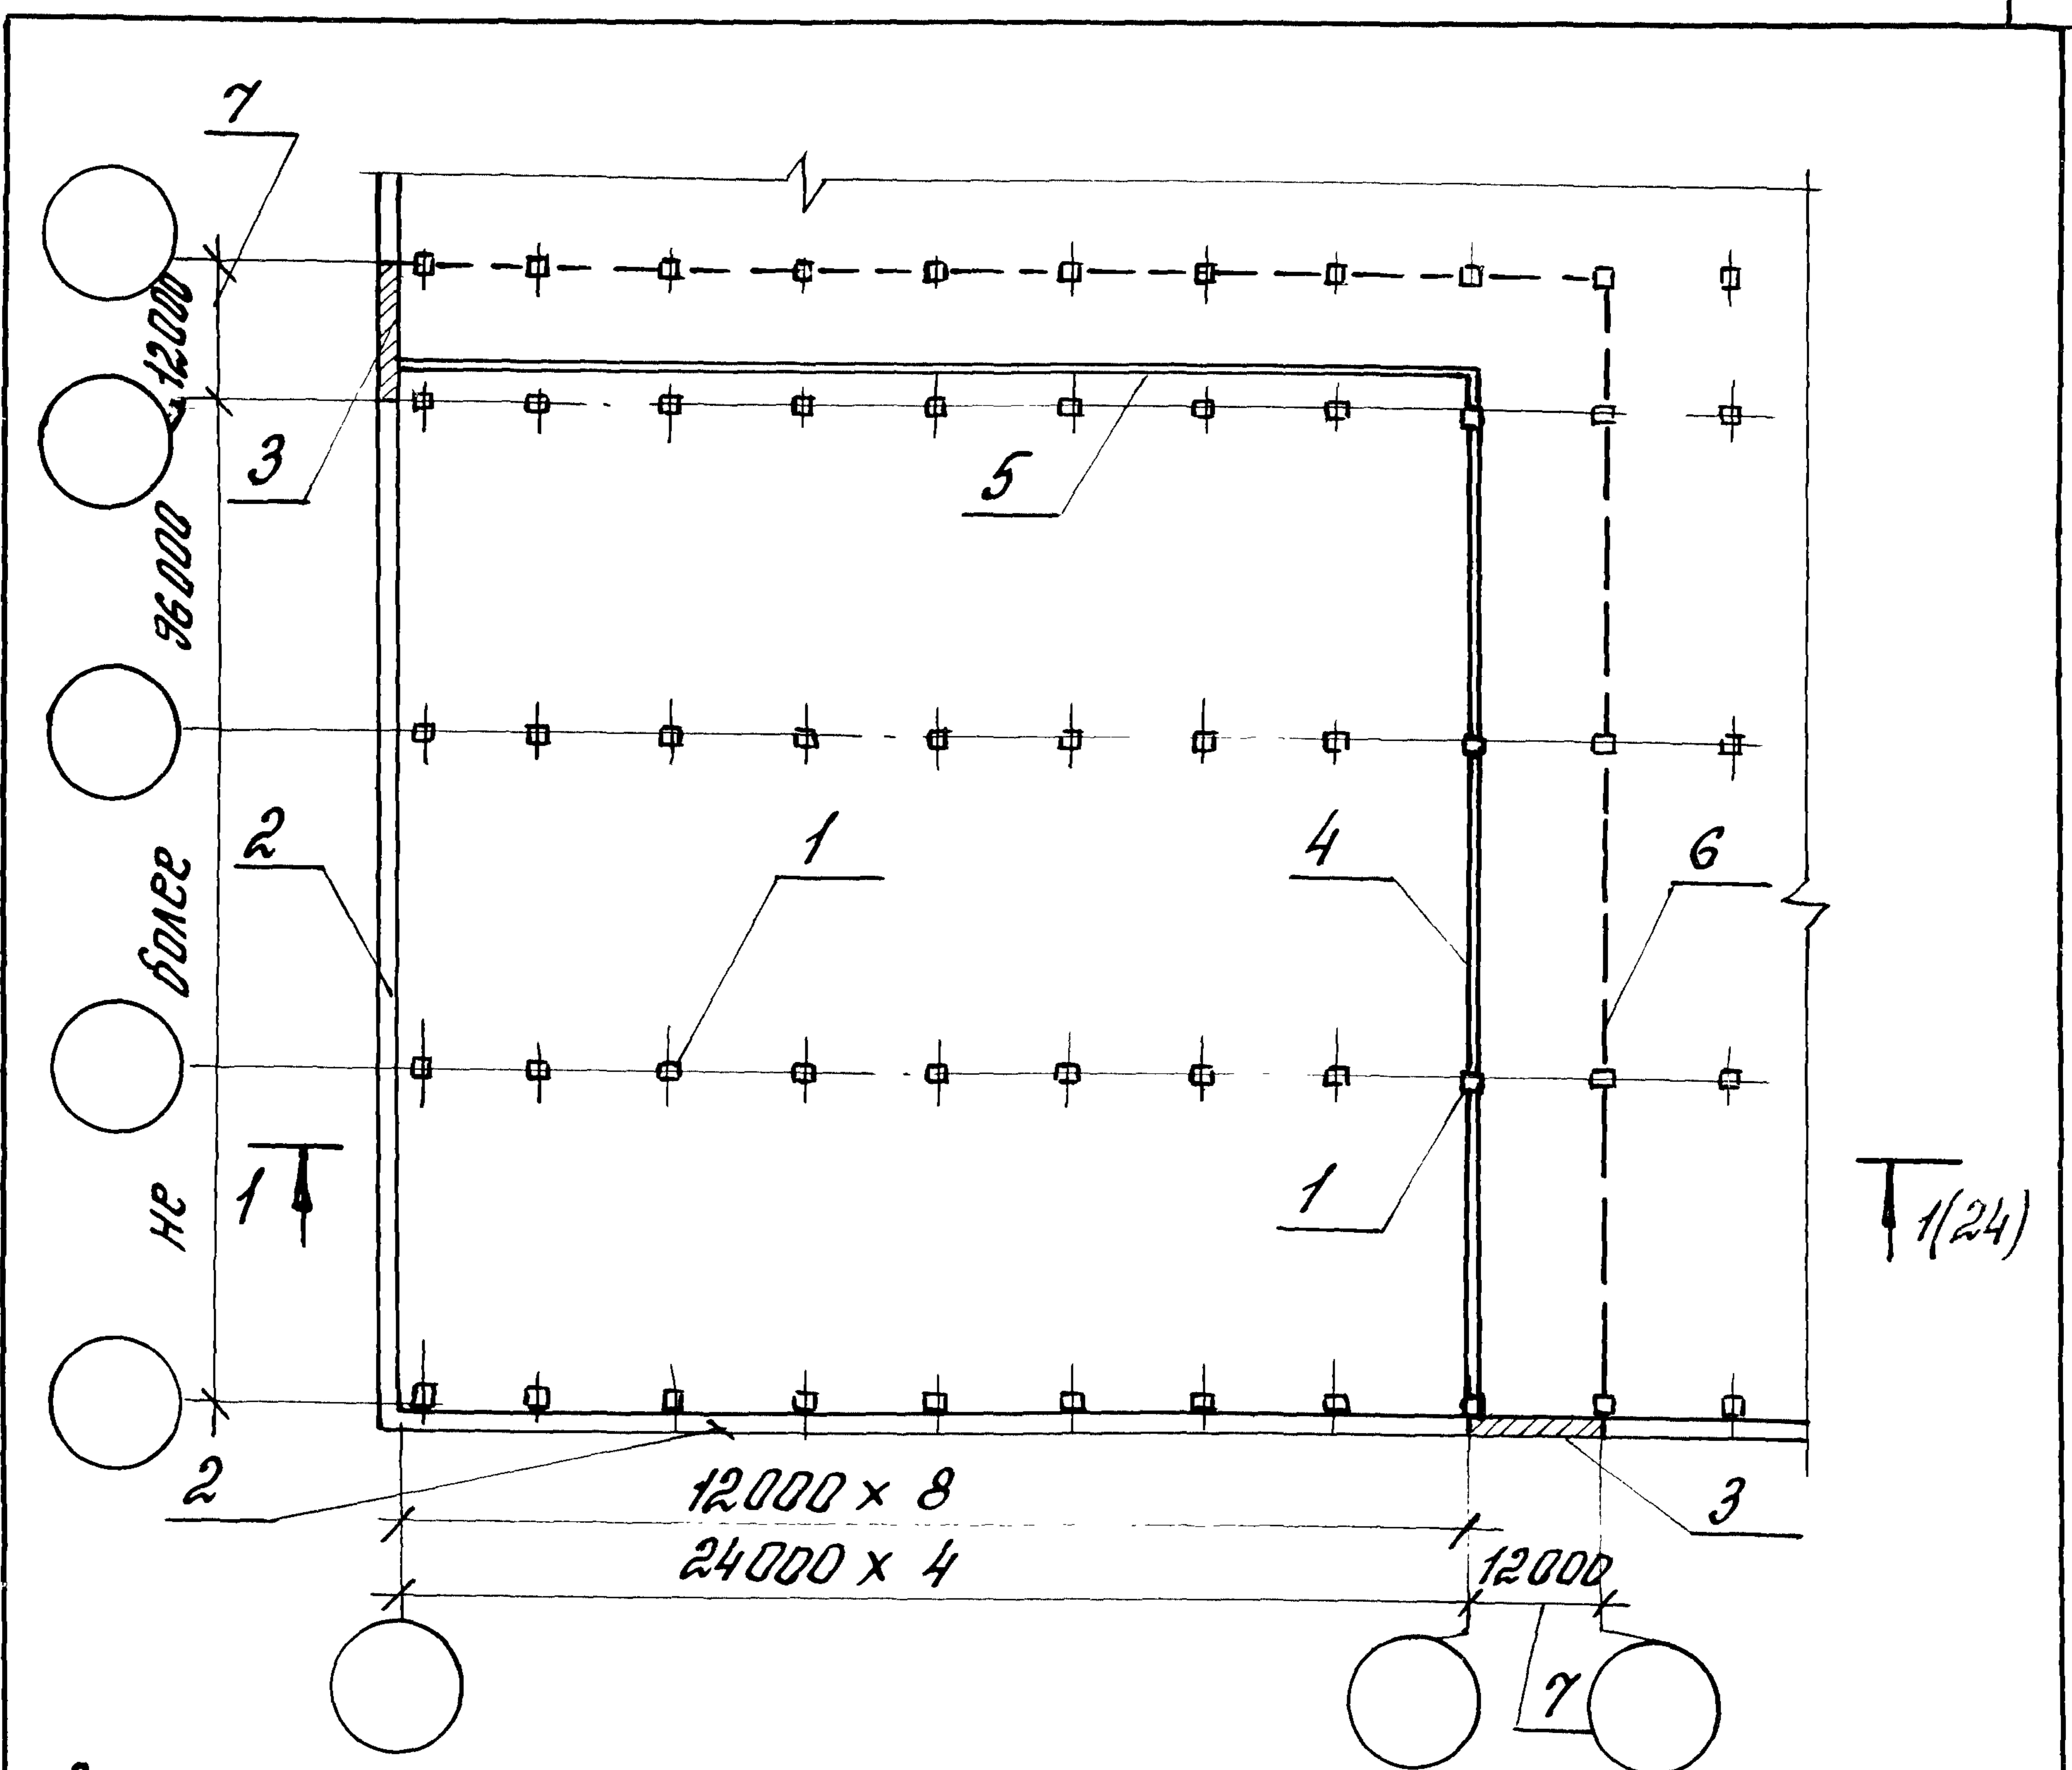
Пример расположения противопожарных перегородок и диафрагм в составе противопожарного пояса, разделяющего конструкции покрытия и стен из горючих и трудногорючих материалов
